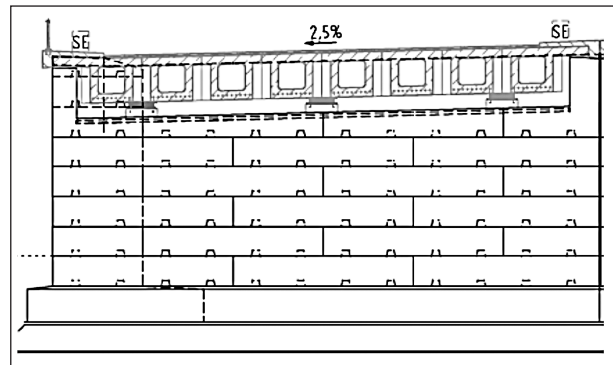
Ansicht Widerlager, Modulbauweise mit Blocksteinen (Breite 3 m)
